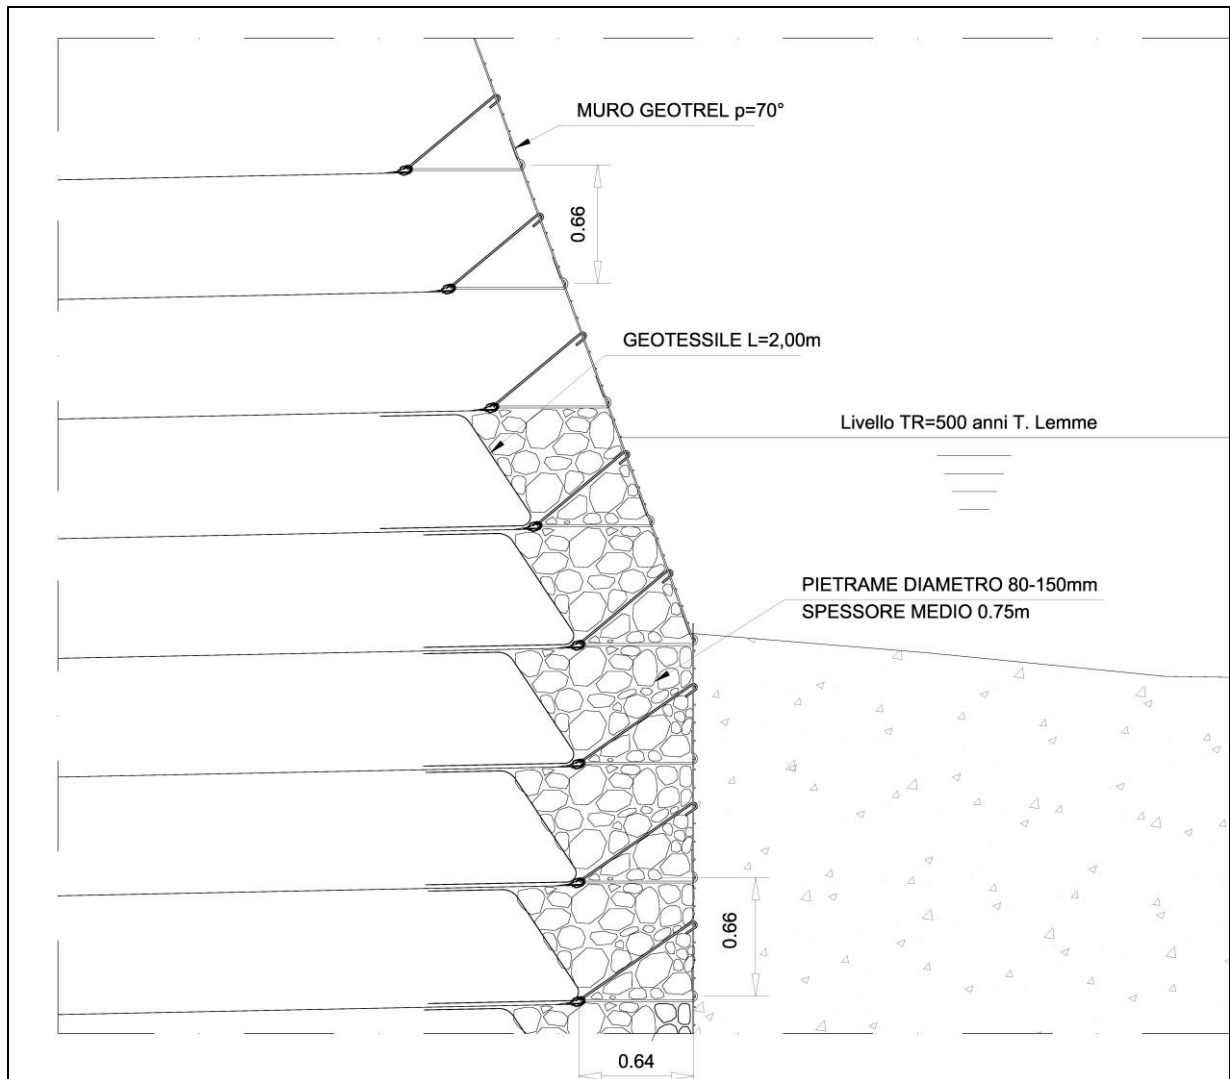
Sezione tipo protezione al piede delle terre rinforzate
